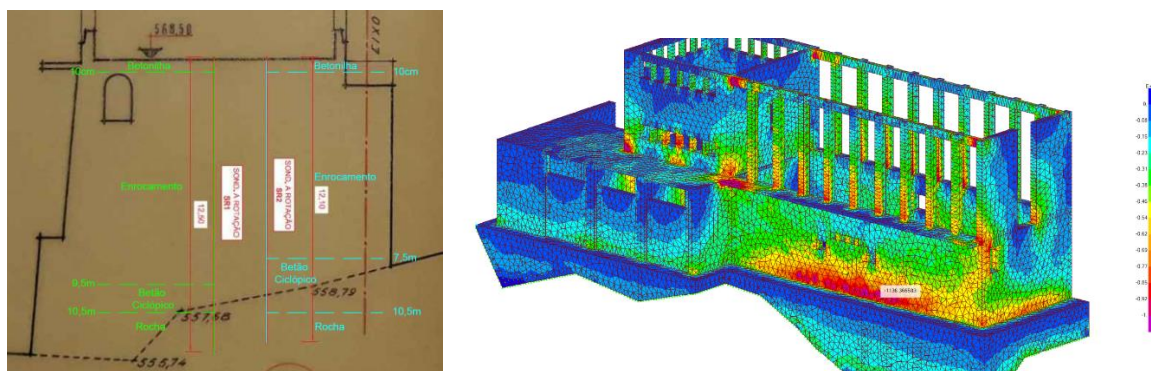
Caracterização da fundação existente; modelação tridimensional das estruturas existentes em alvenaria e betão armado, do edifício da central.
